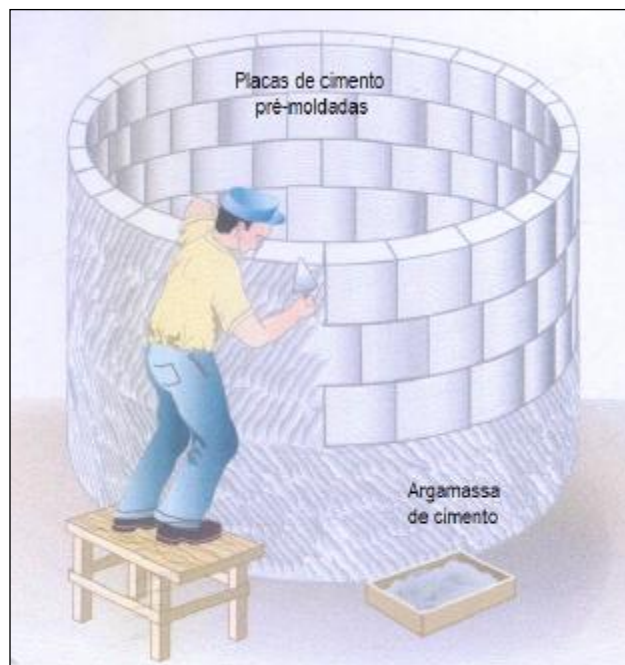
Cisterna de placas de cimento pré-moldadas.
